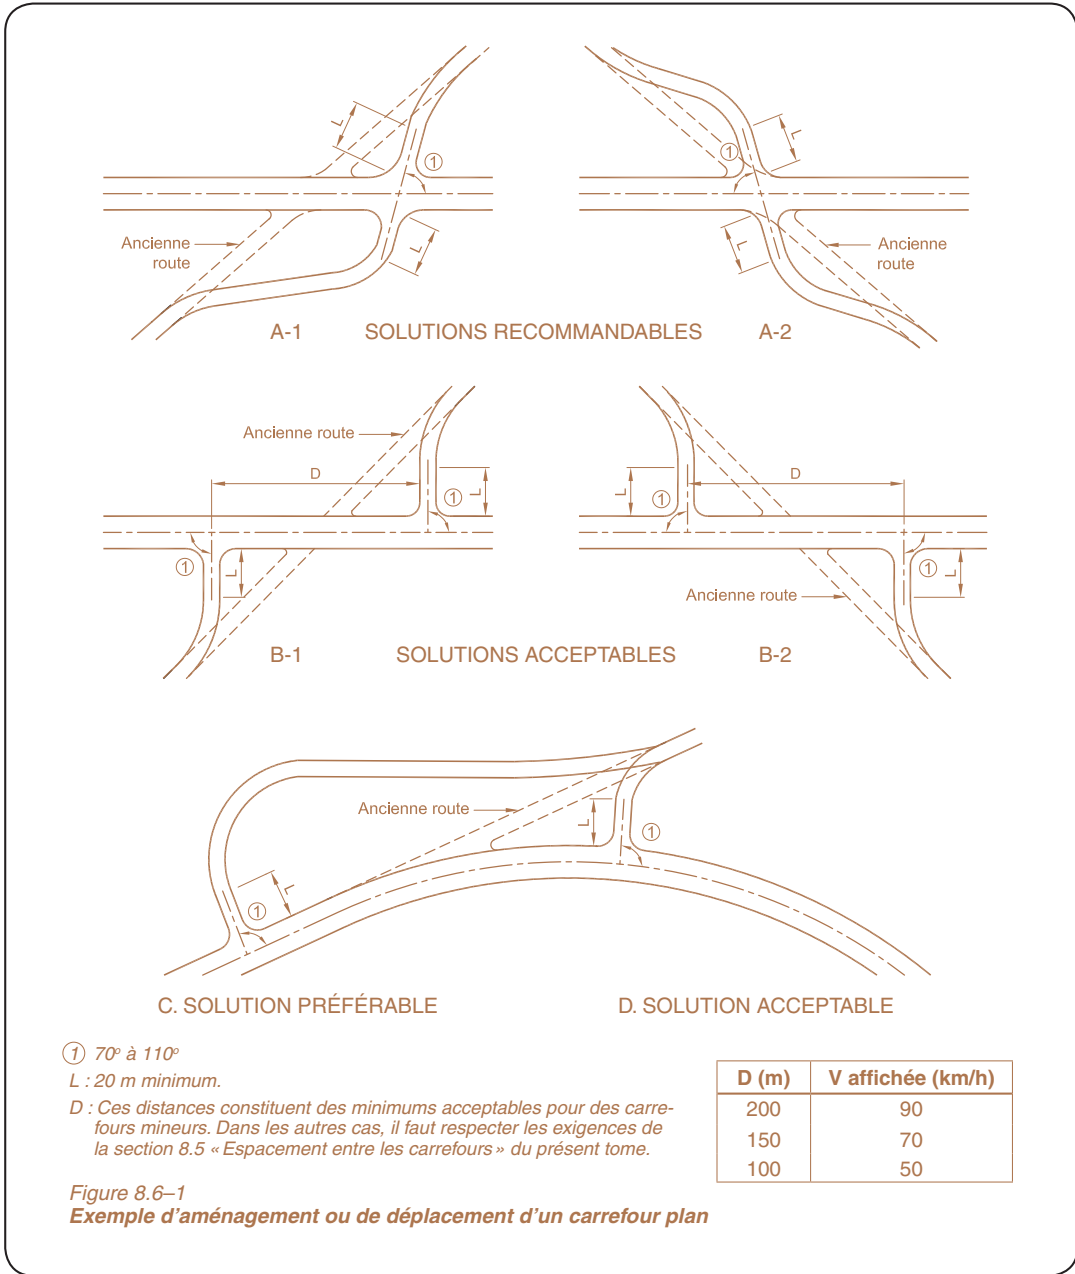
Aménagement ou déplacement d'un carrefour plan
